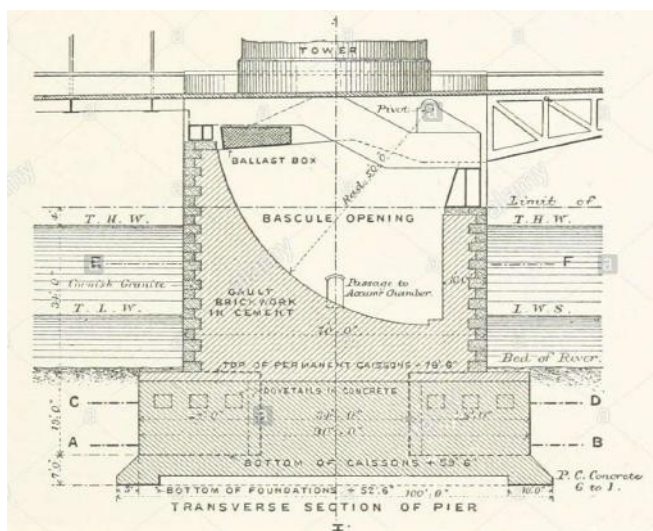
Kellerraum unter den Turm, zum Einschwenken des Gegengewichts und der Zahnradsektoren
